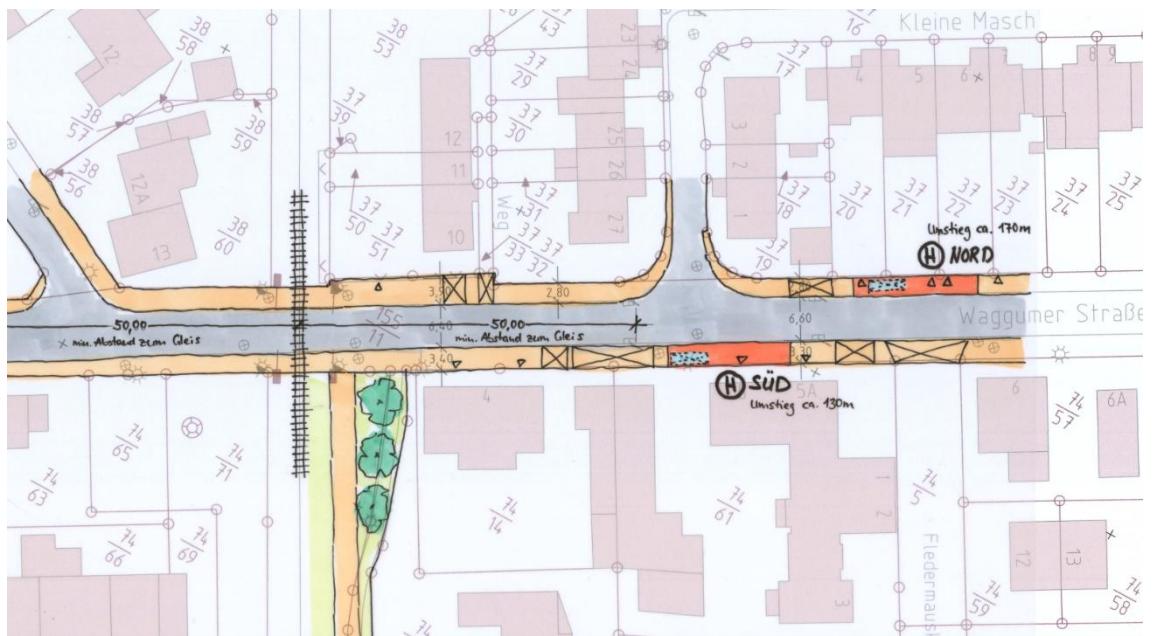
Lageplanausschnitt Haltestellen Waggumer Straße
